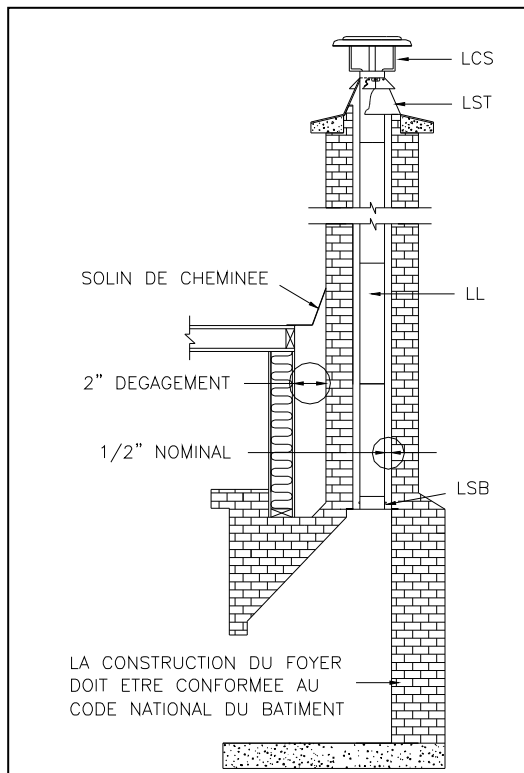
Installation d'un conduit de tubage dans un nouveau foyer
